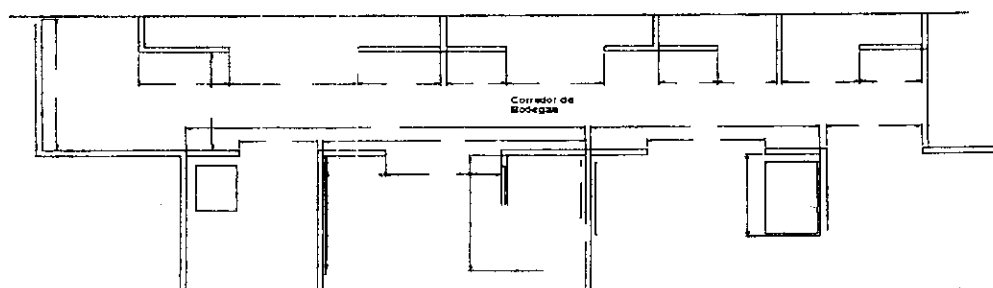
PLANO CORREDOR DE BODEGAS
